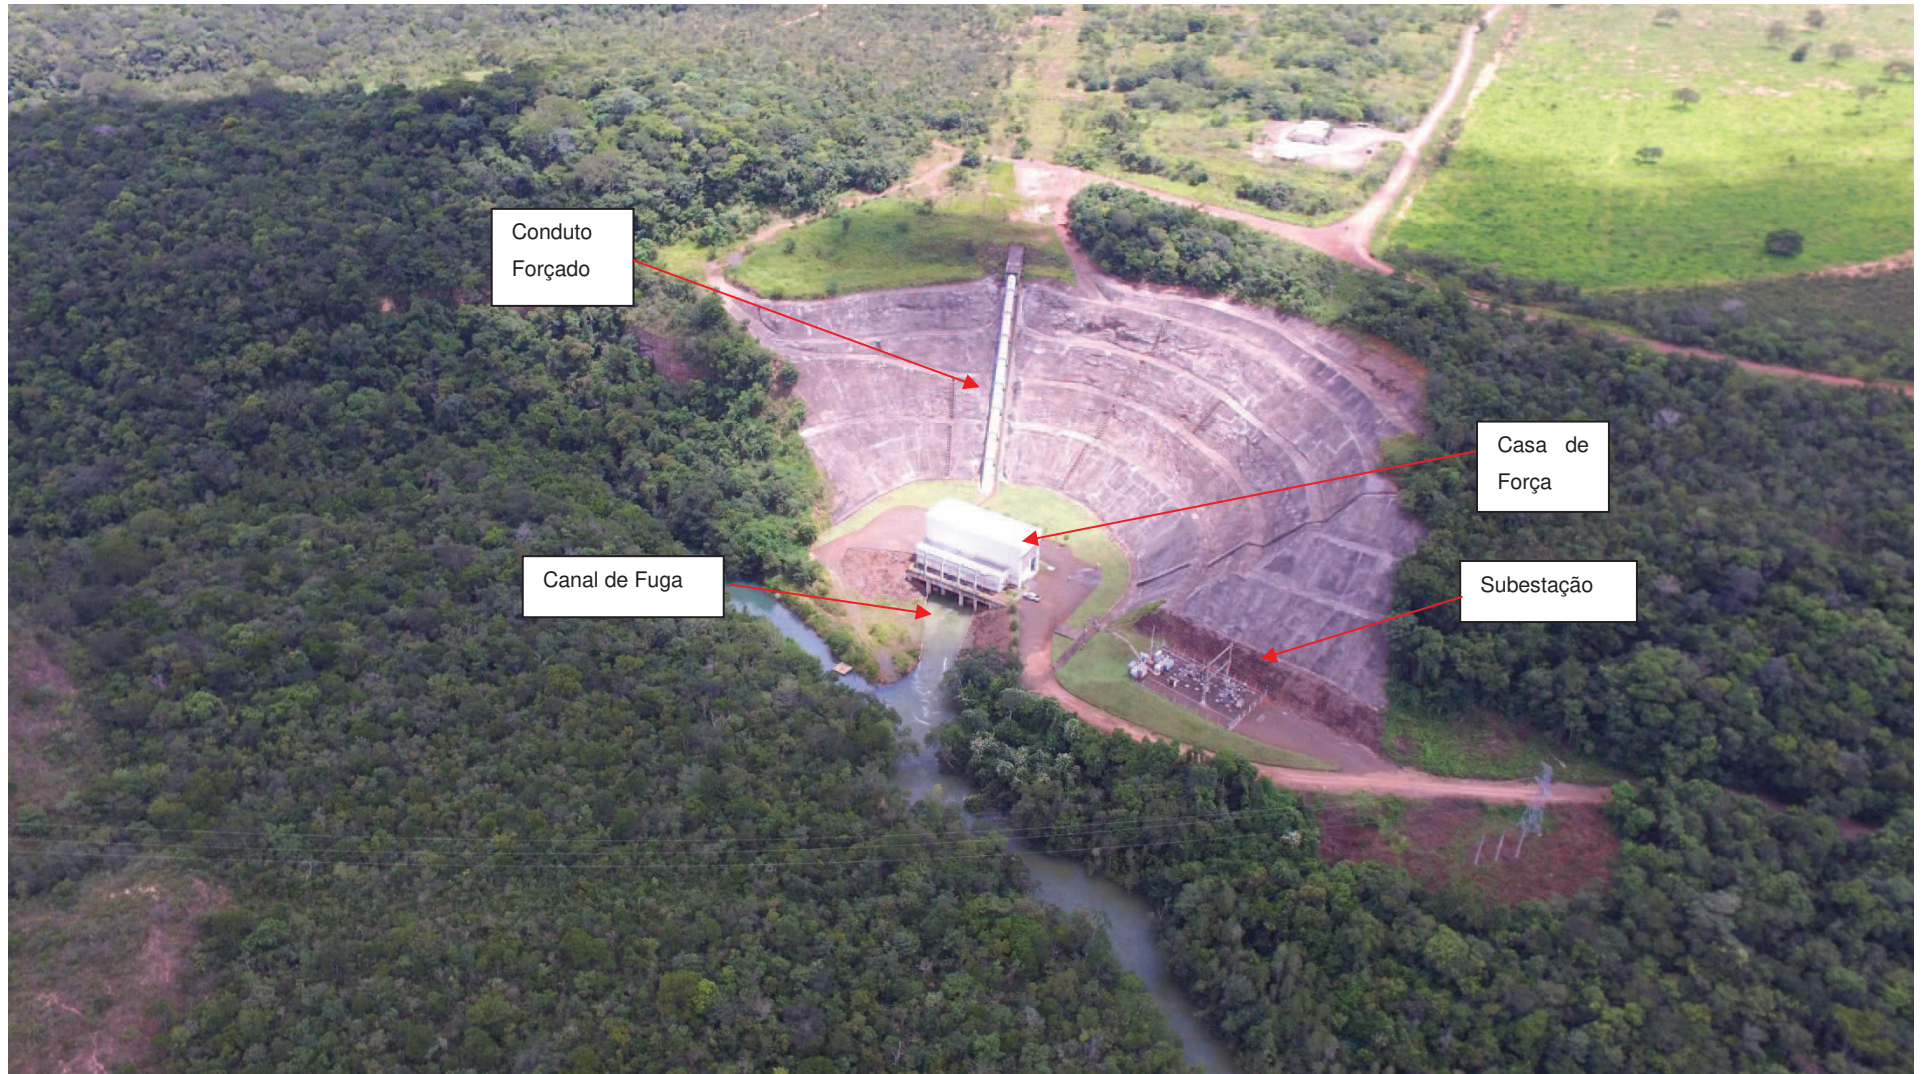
Vista Geral das estruturas de jusante da PCH Planalto
